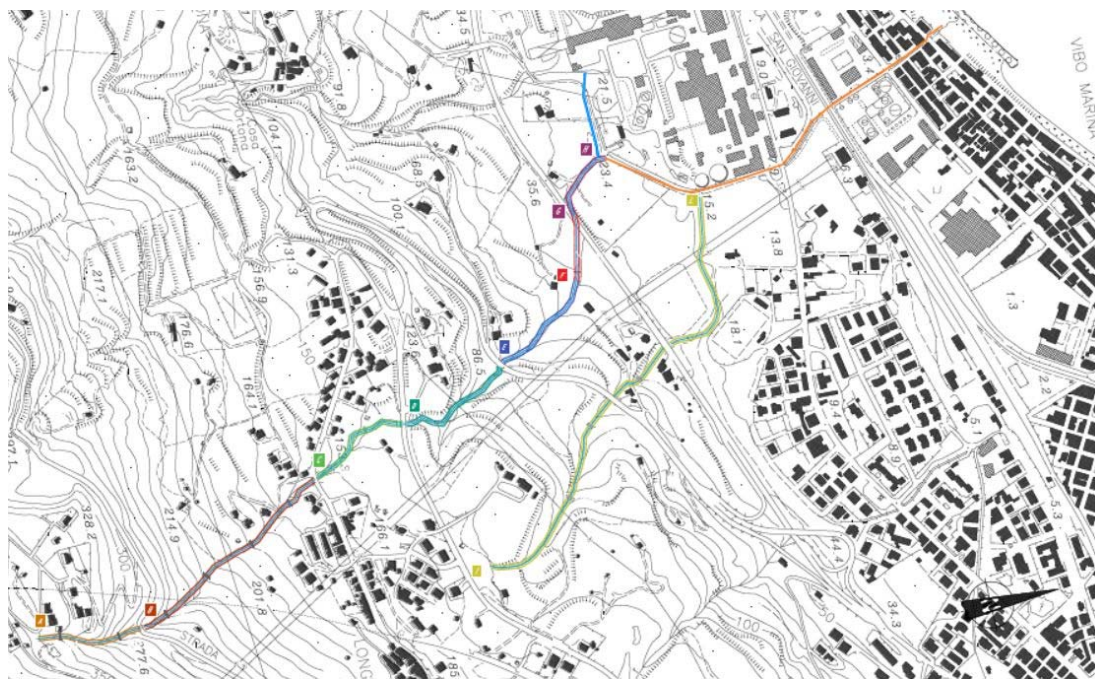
Suddivisione in tratti dell'area oggetto degli interventi
